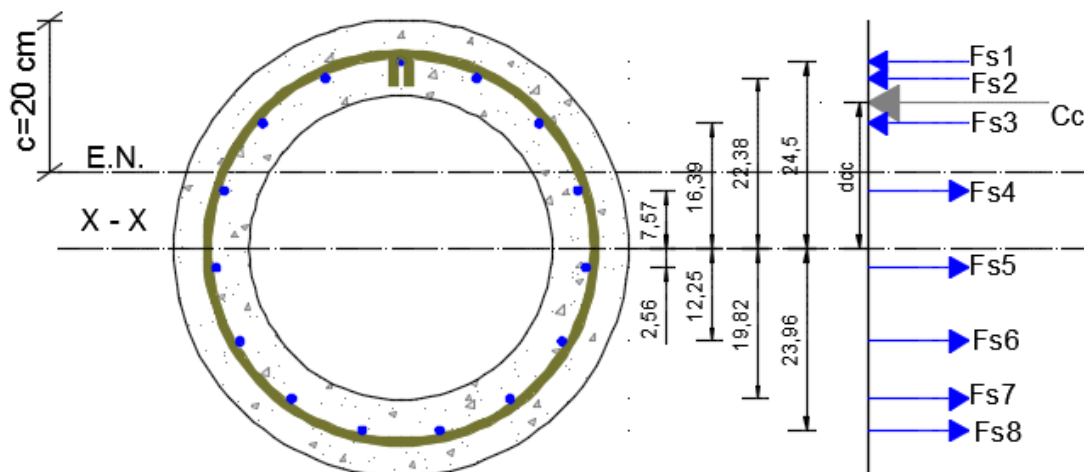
Esquema general de deformaciones, esfuerzos y fuerzas en la sección transversal circular
